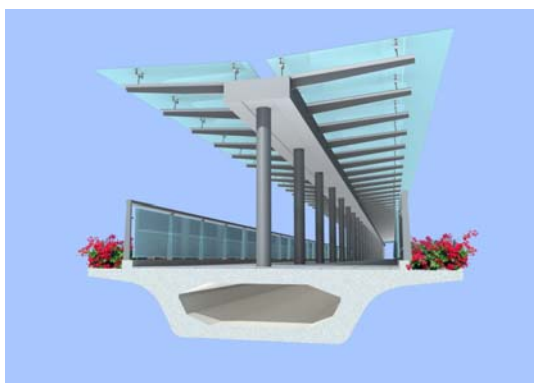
普通钢筋混凝土或预应力混凝土结构
